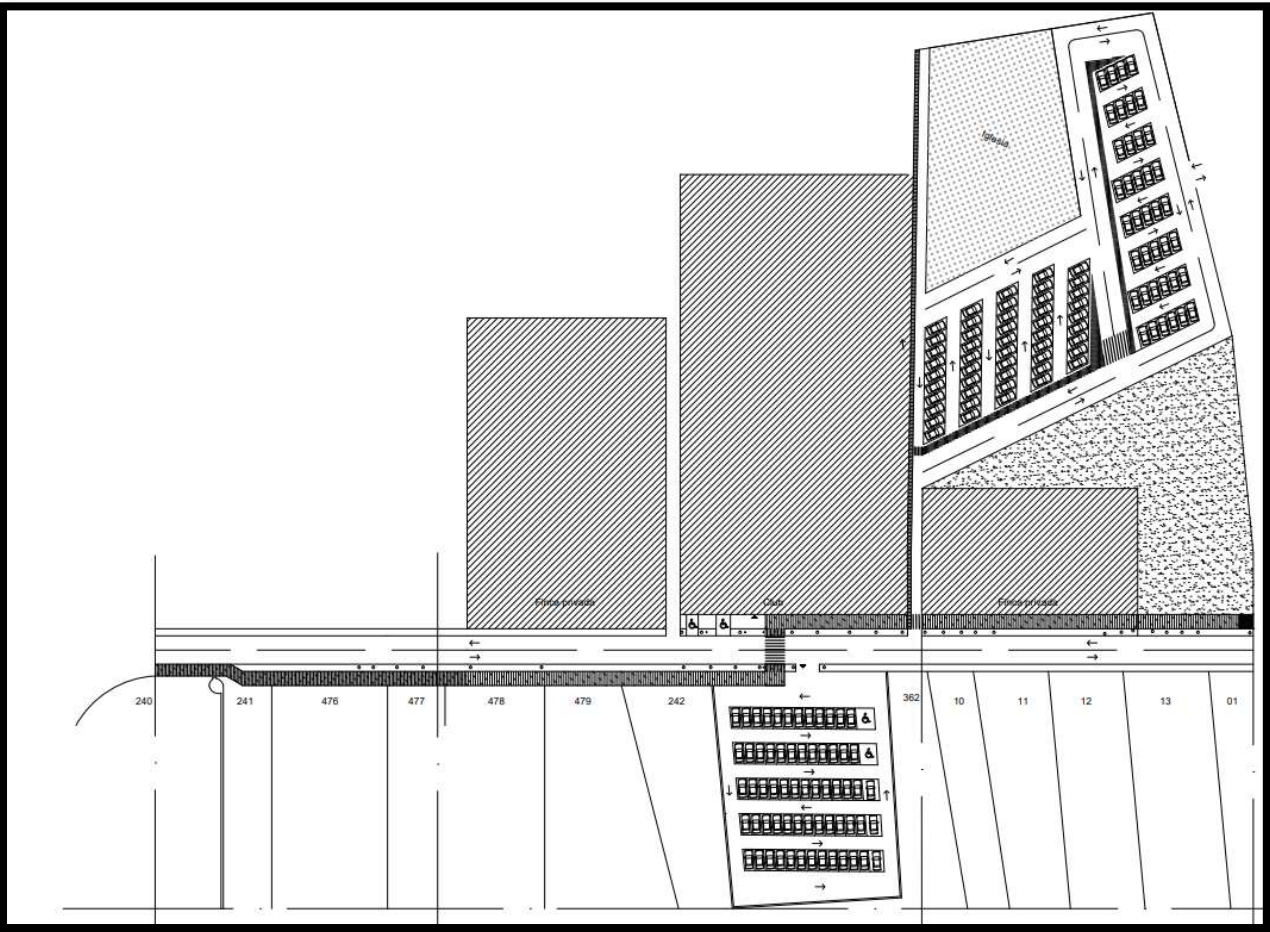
Planta zona después de la actuación. Fuente: Elaboración propia
